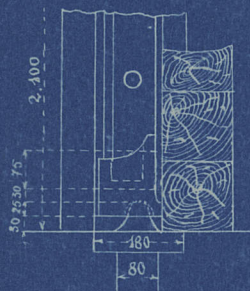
Barrage à poutrelles dans la Seille (Saône)
